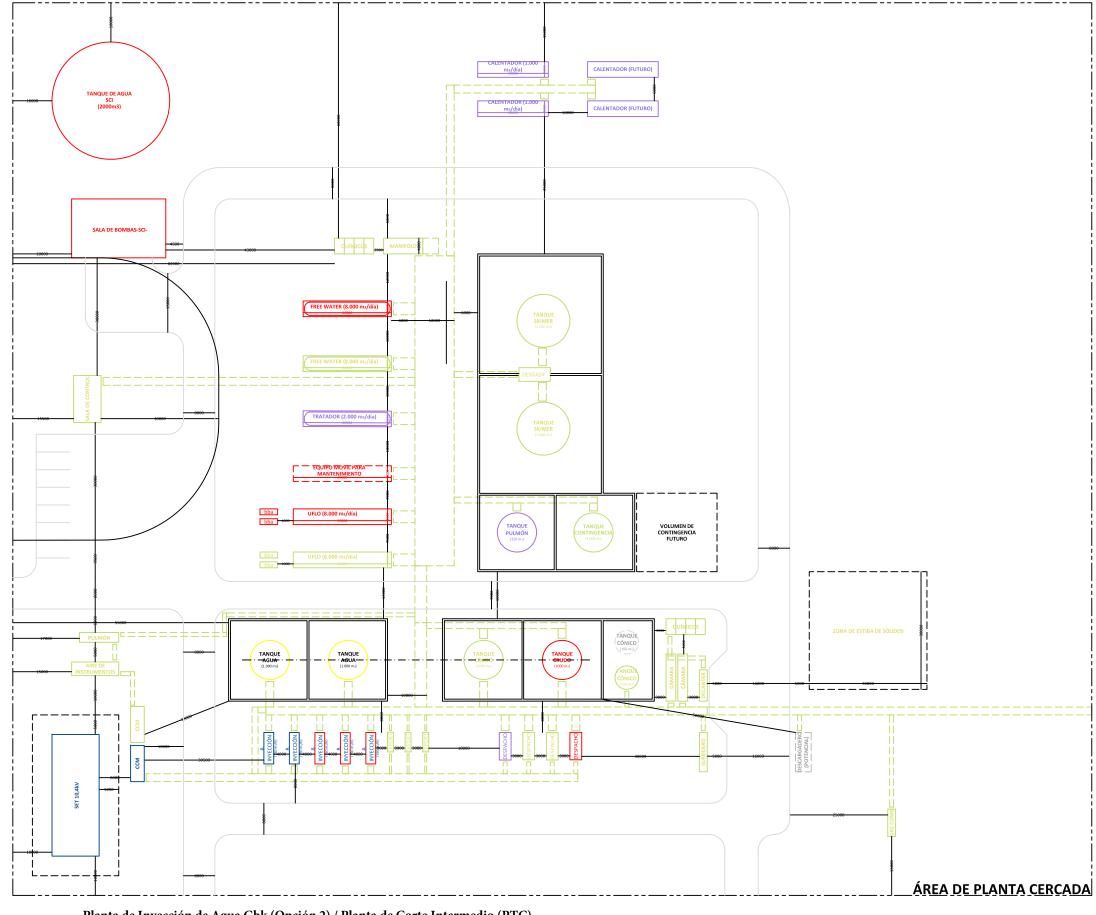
Alternativa de emplazamiento de Futura Planta de Inyección de Agua Grimbeek (Opción 2)
